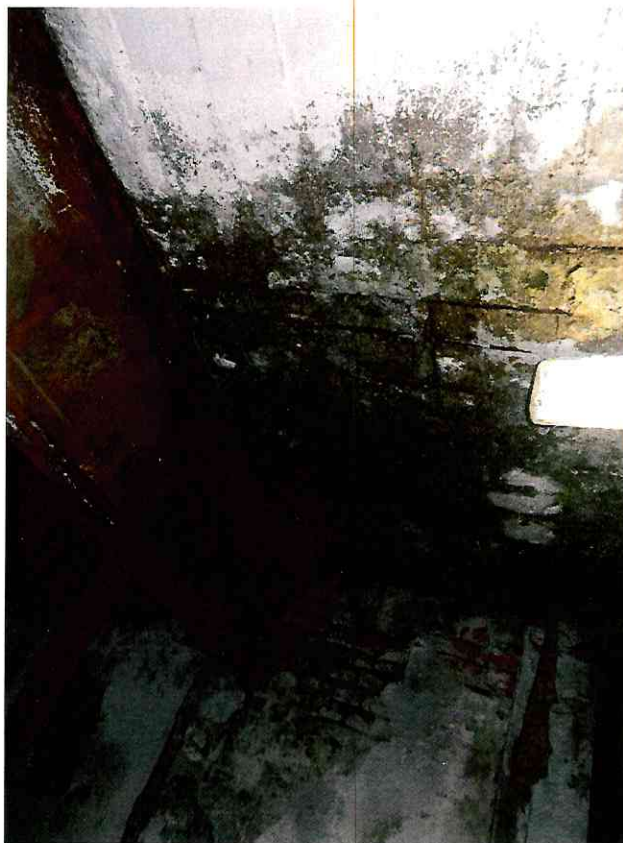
Перекрытие подвала в осях 3'-1'/Л-К. Участок отслоения защитного слоя бетона с обнажением коррозией и вырезом арматуры
